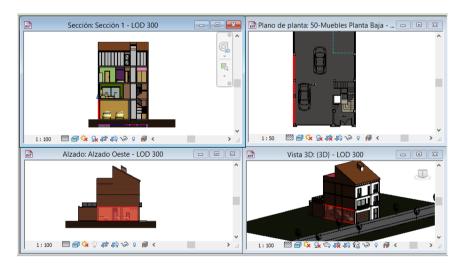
Selección muro planta baja. 2014. Elaboración propia.
